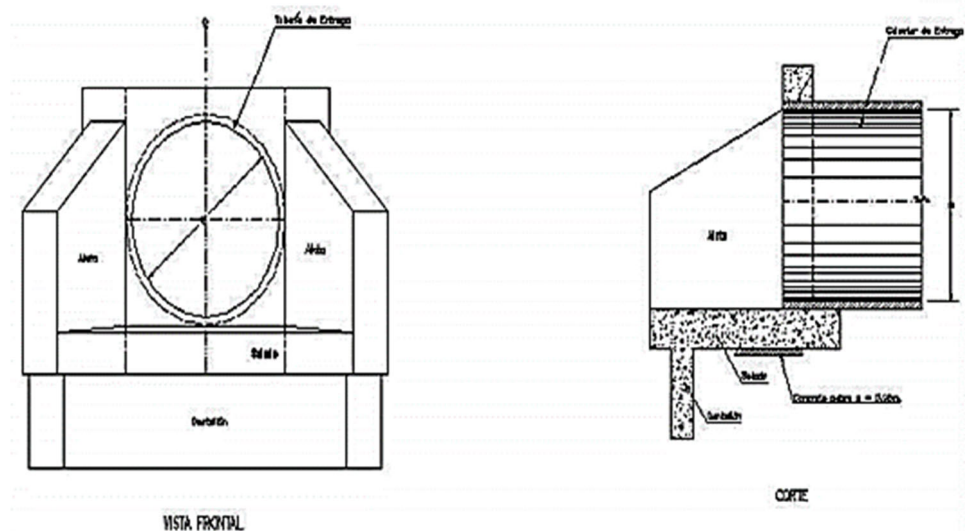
Detalle típico de cabezal. Fuente: Partes Específicas del Sistema de Alcantarillado de Aguas Lluvias, Ponencia de Abastecimiento de Agua y Alcantarillado, año 2009.
